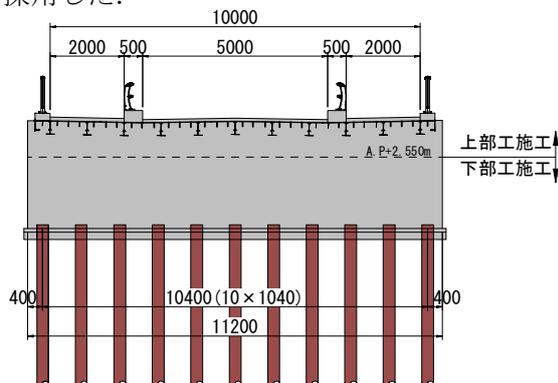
橋台正面図(幅員構成)と杭配置(単位: mm)
